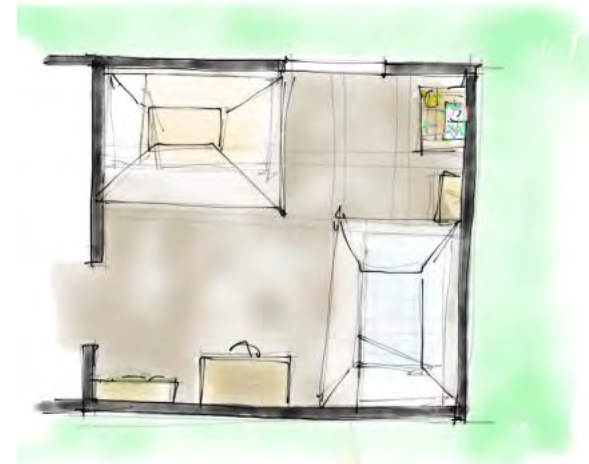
Esquemas en planta de distribución y acceso de los dormitorios.
